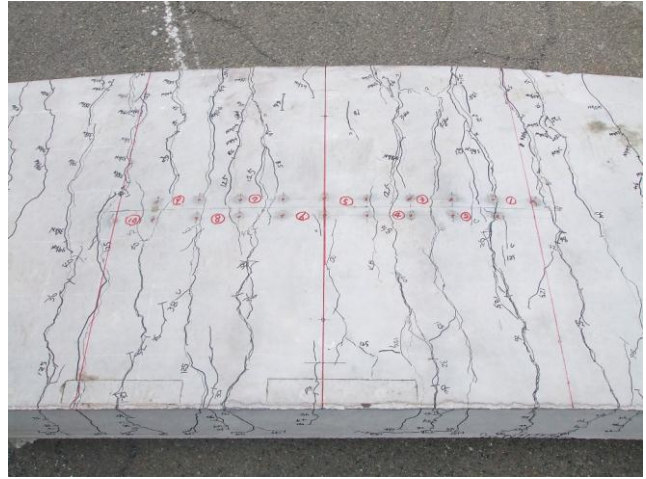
実験終了後のひび割れ性状 (C2 供試体)
